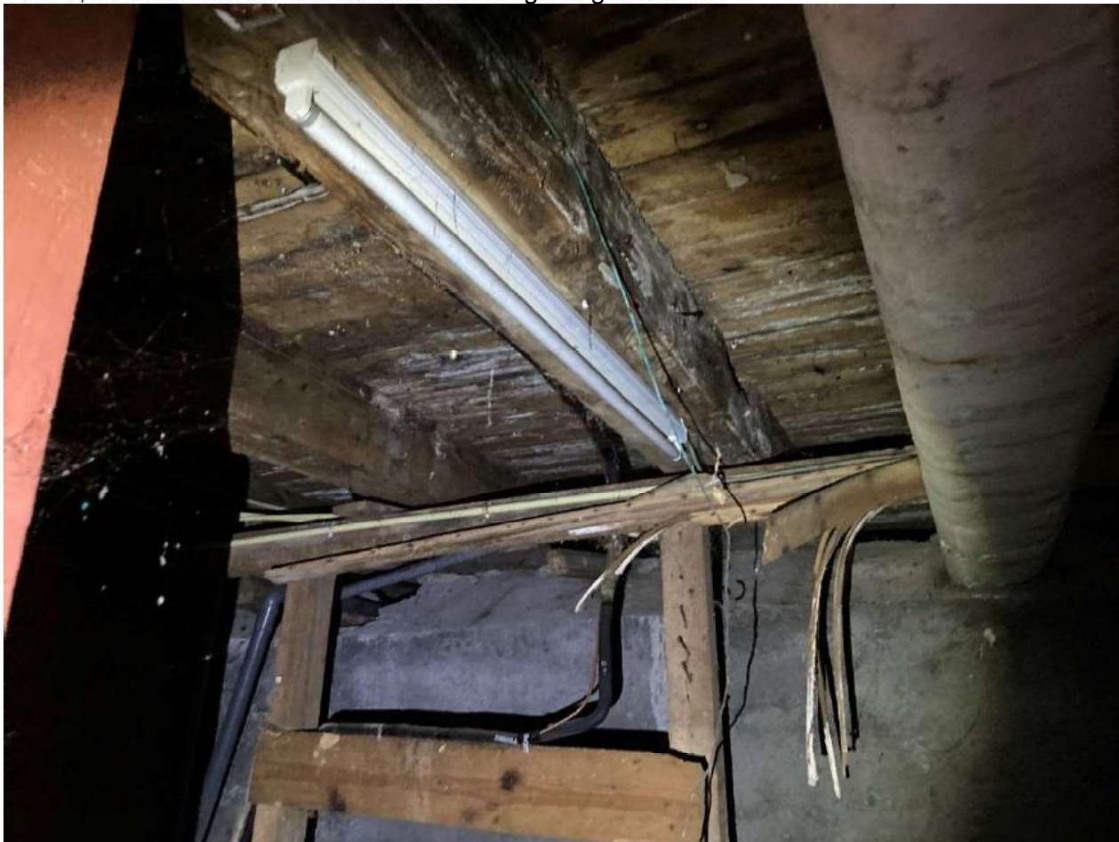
, begane grond is slecht door lekkages en vocht door leegstand.
